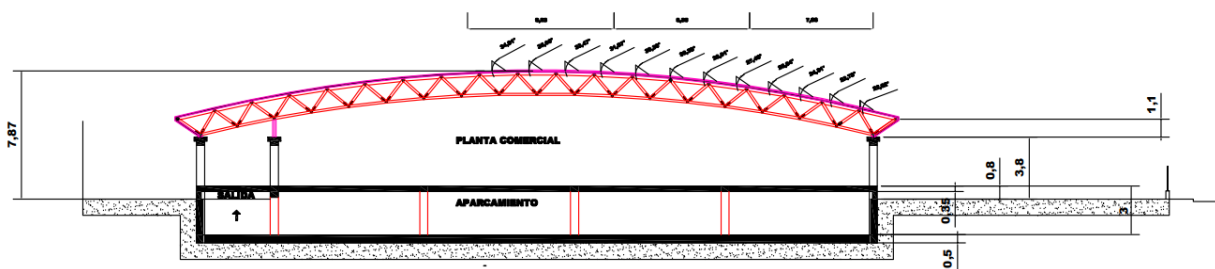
Distribución de pórticos de fachada e intermedios en hormigón
